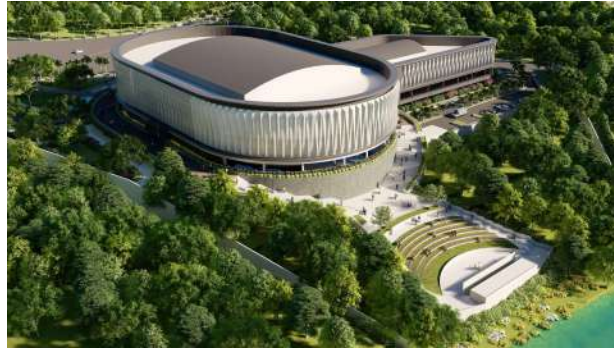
Gubahan Massa Pada Blok Plan.
